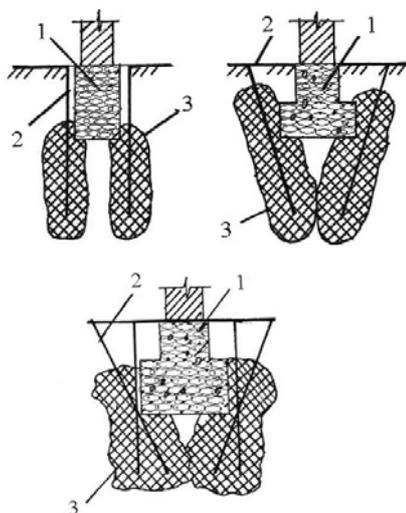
Принципиальные схемы усиления оснований фундаментов инъекционными методами:
